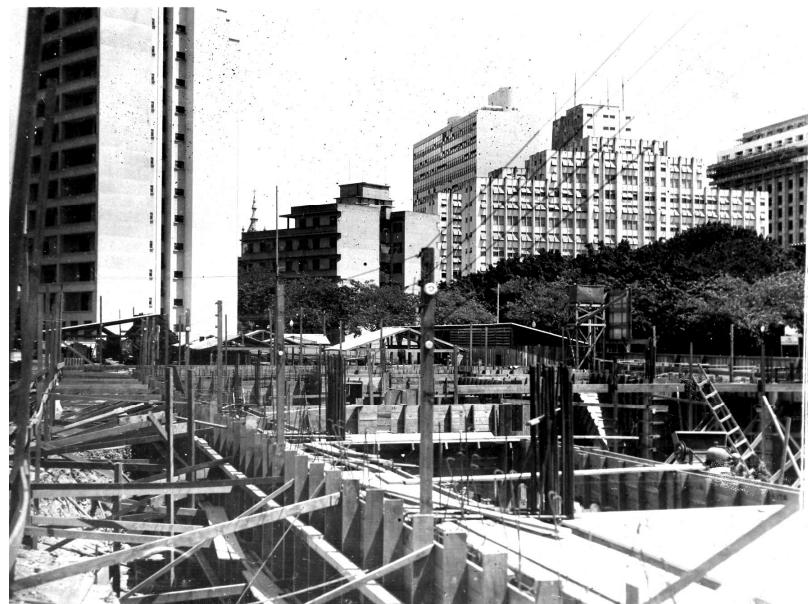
F – Foto do processo de concretagem das vigas no segundo pavimento
